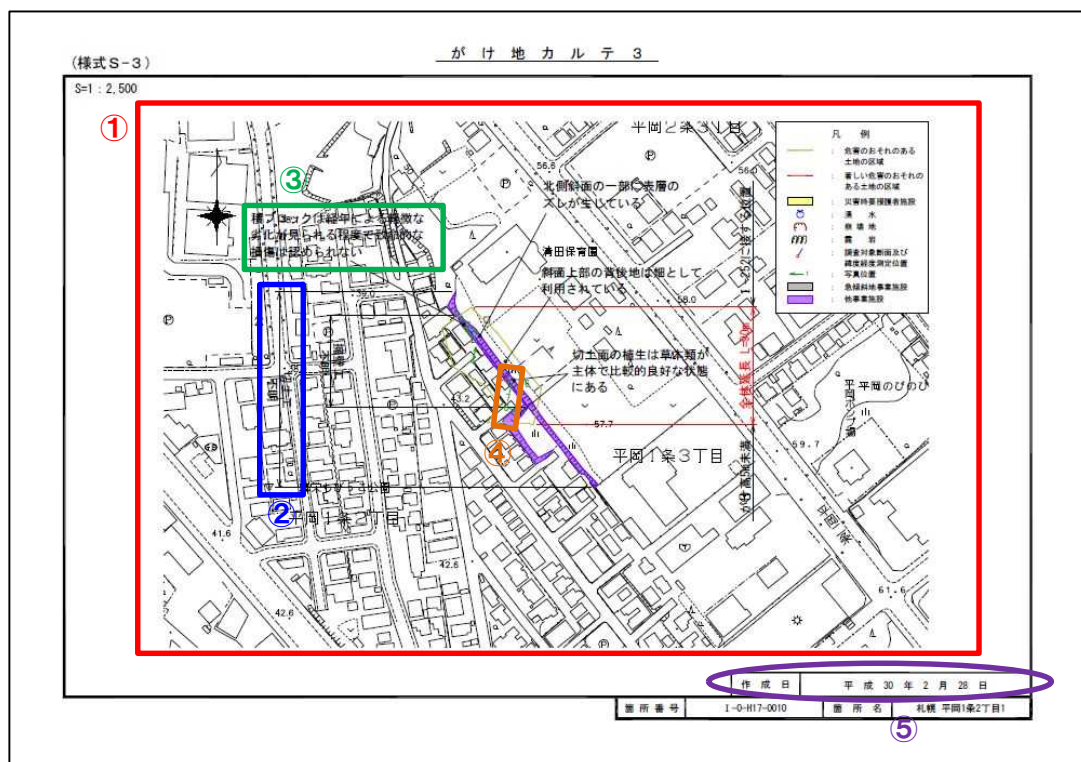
がけ地カルテ3 (様式 S-3) 平面図
